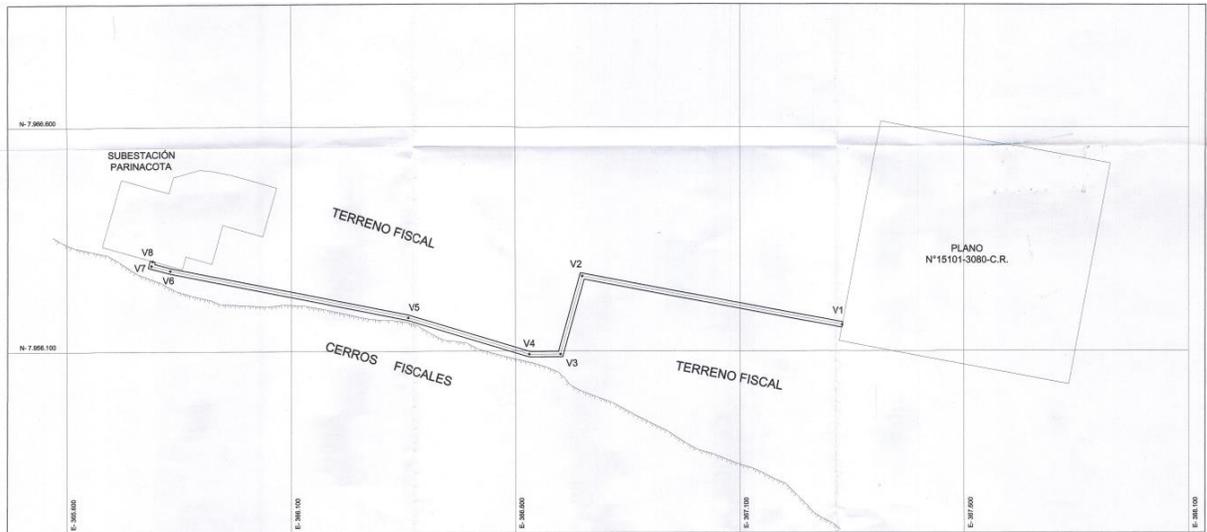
Vista de plata del plano de la Servidumbre Eléctrica, Plano N° 15101-3562-C.R.
